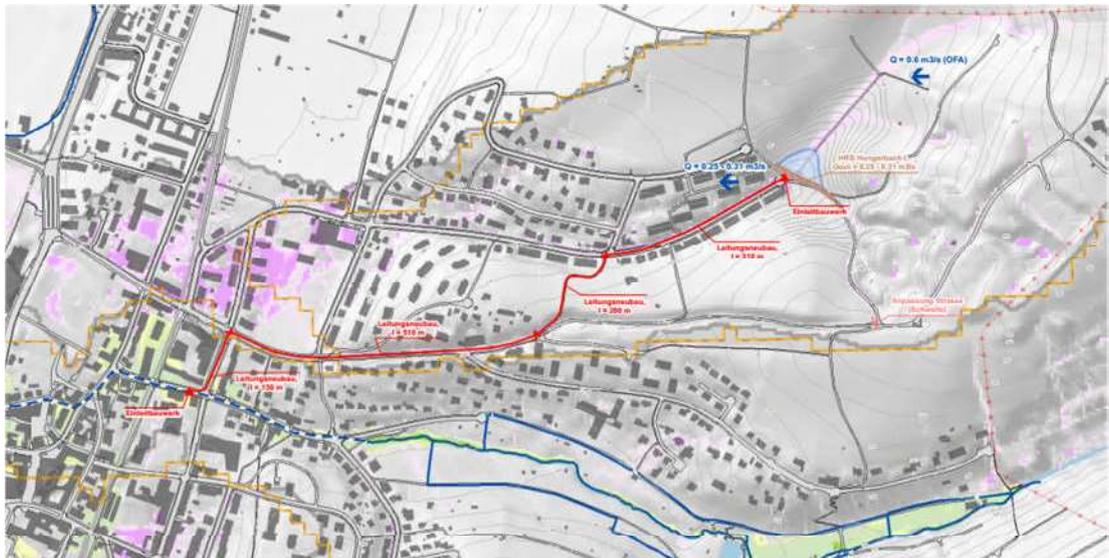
Ausschnitt aus dem Situationsplan Variante 2
